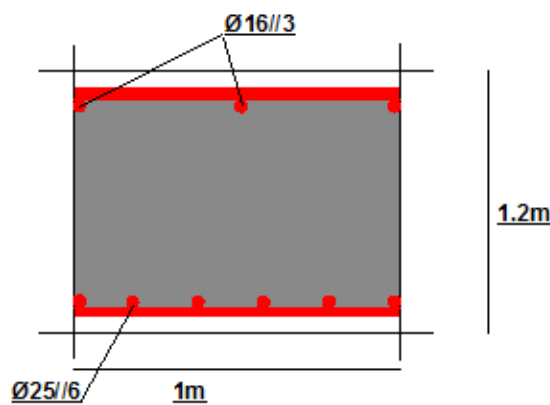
Schéma de ferrailage à mis travée dans la direction longitudinale
